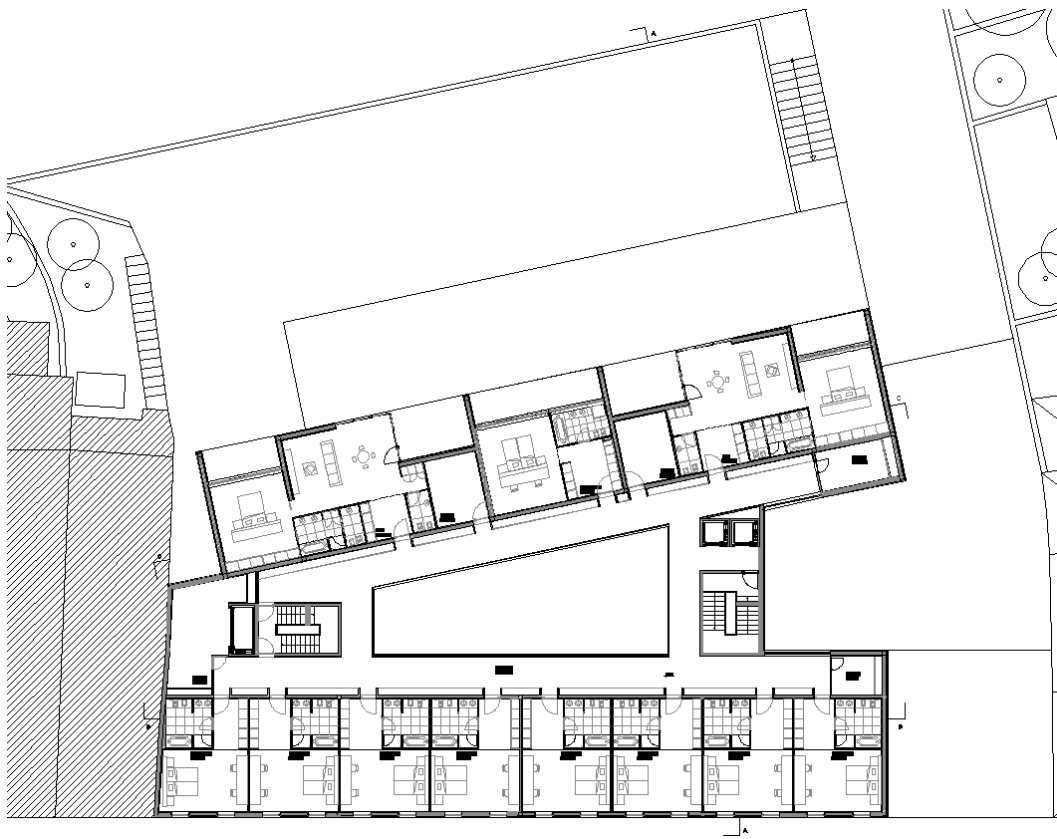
Planta do 1º e 2º piso, fonte: Autor
